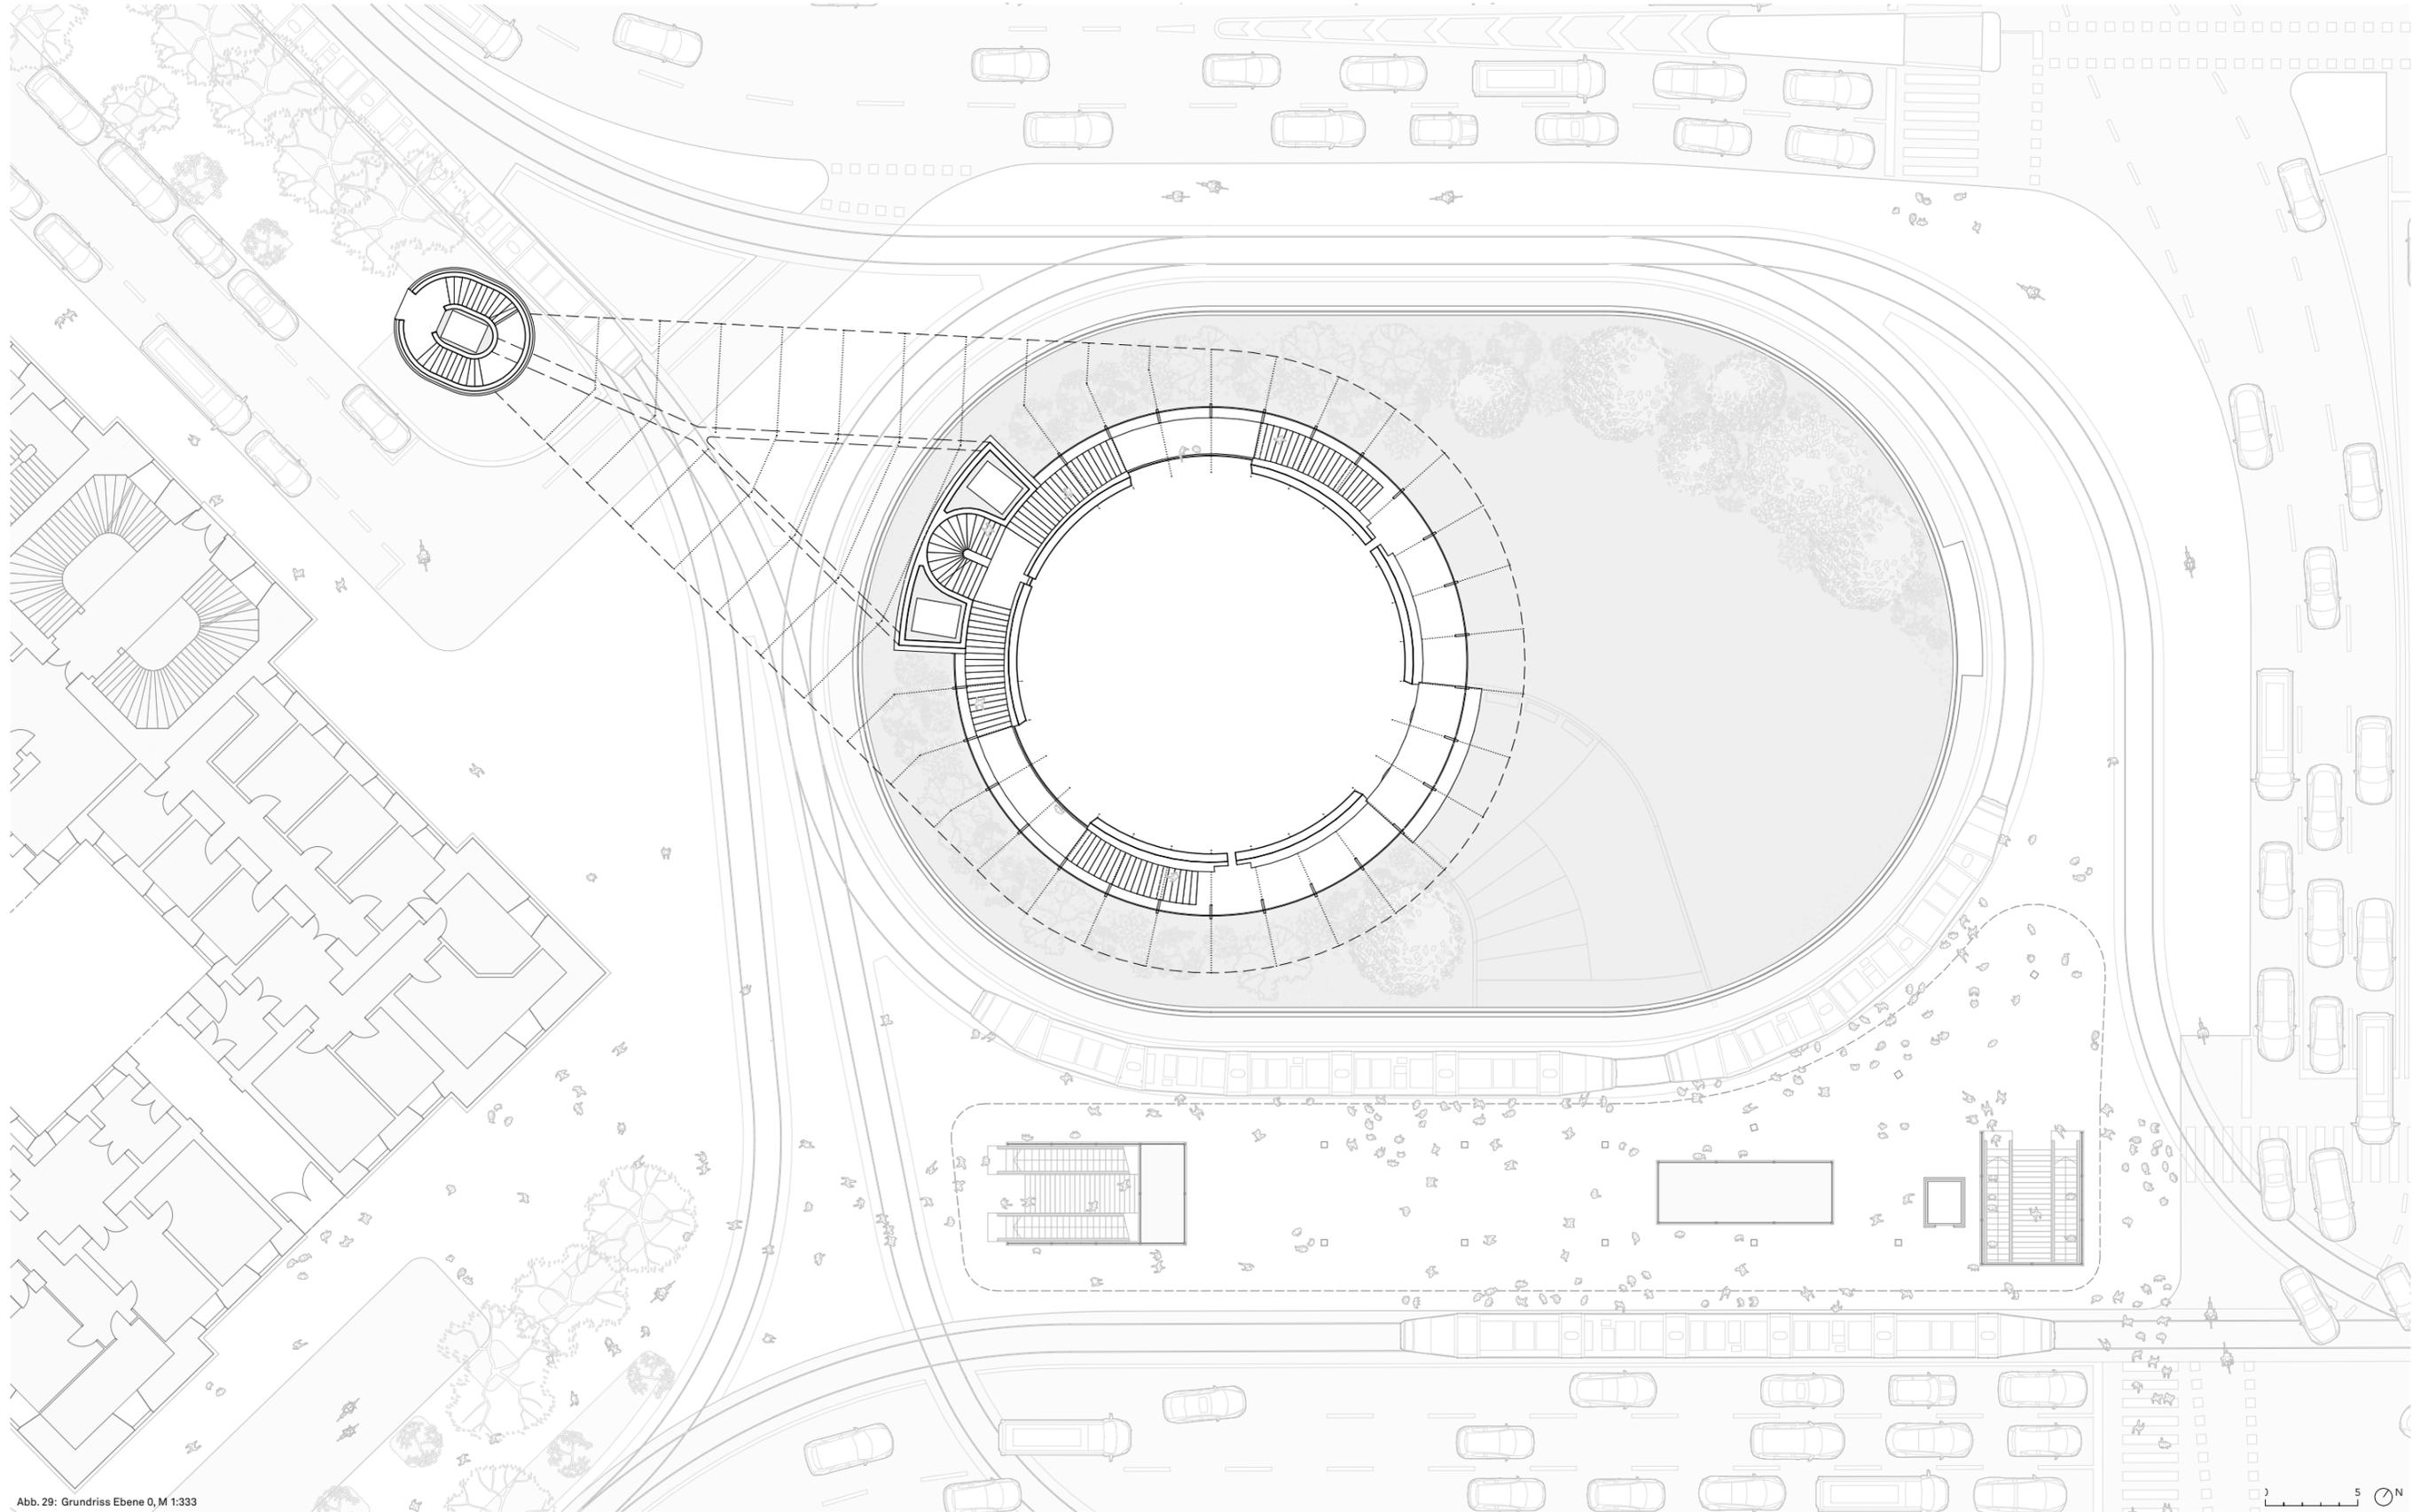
Grundriss Ebene 0, M 1:333
